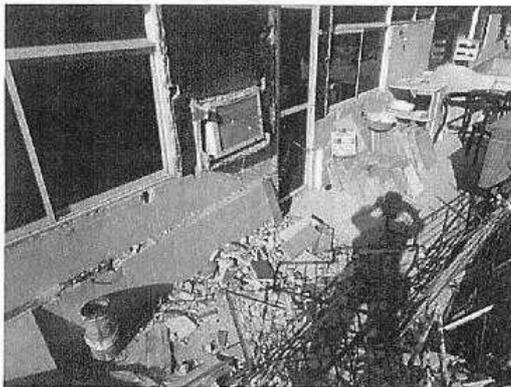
Área acrescida no Apto. 106 com presença de metralha e materiais construtivos sobrecarregando a estrutura.
